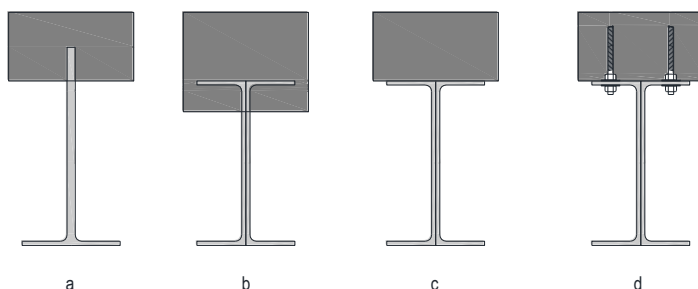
Tipologías de enlace entre el perfil de GFRP y la capa de compresión del hormigón.
